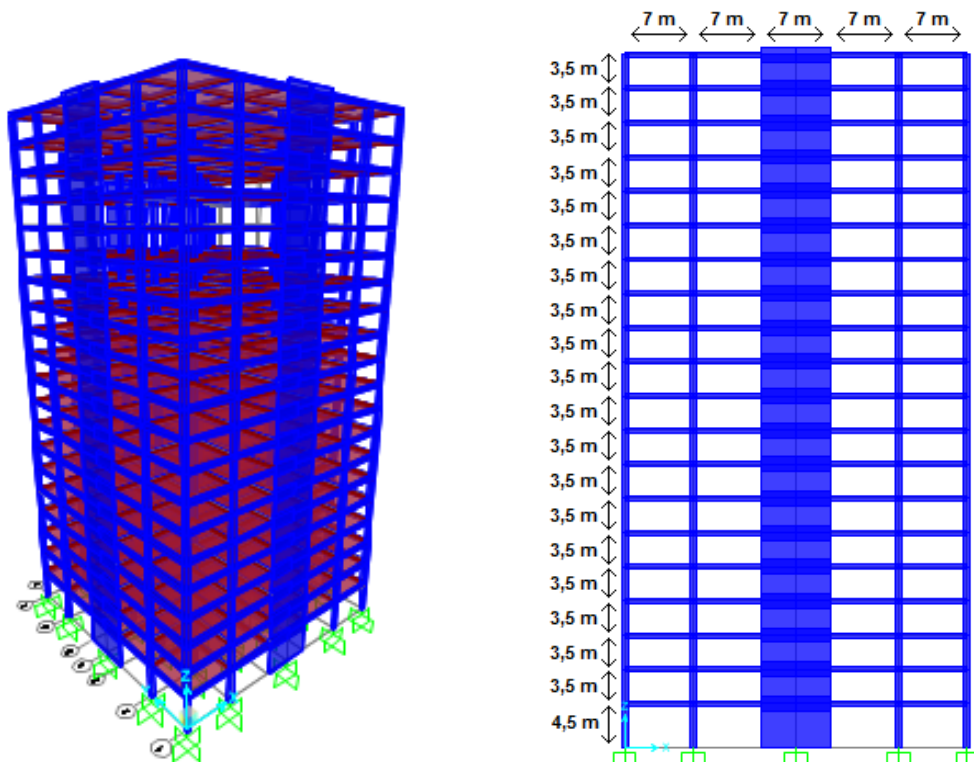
Geometría 3D y elevación exterior del edificio en base a 1 muro exterior
